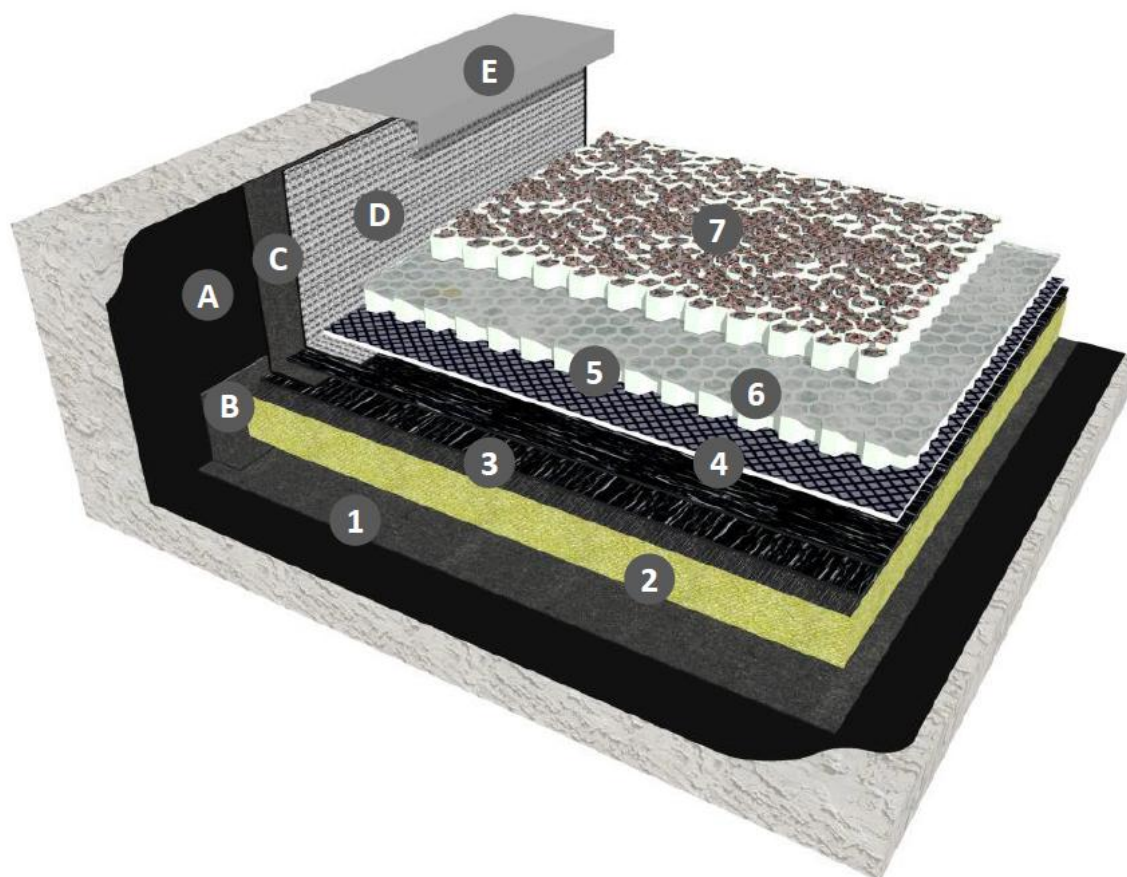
Toiture-terrasse inaccessible avec protection par gravillons
